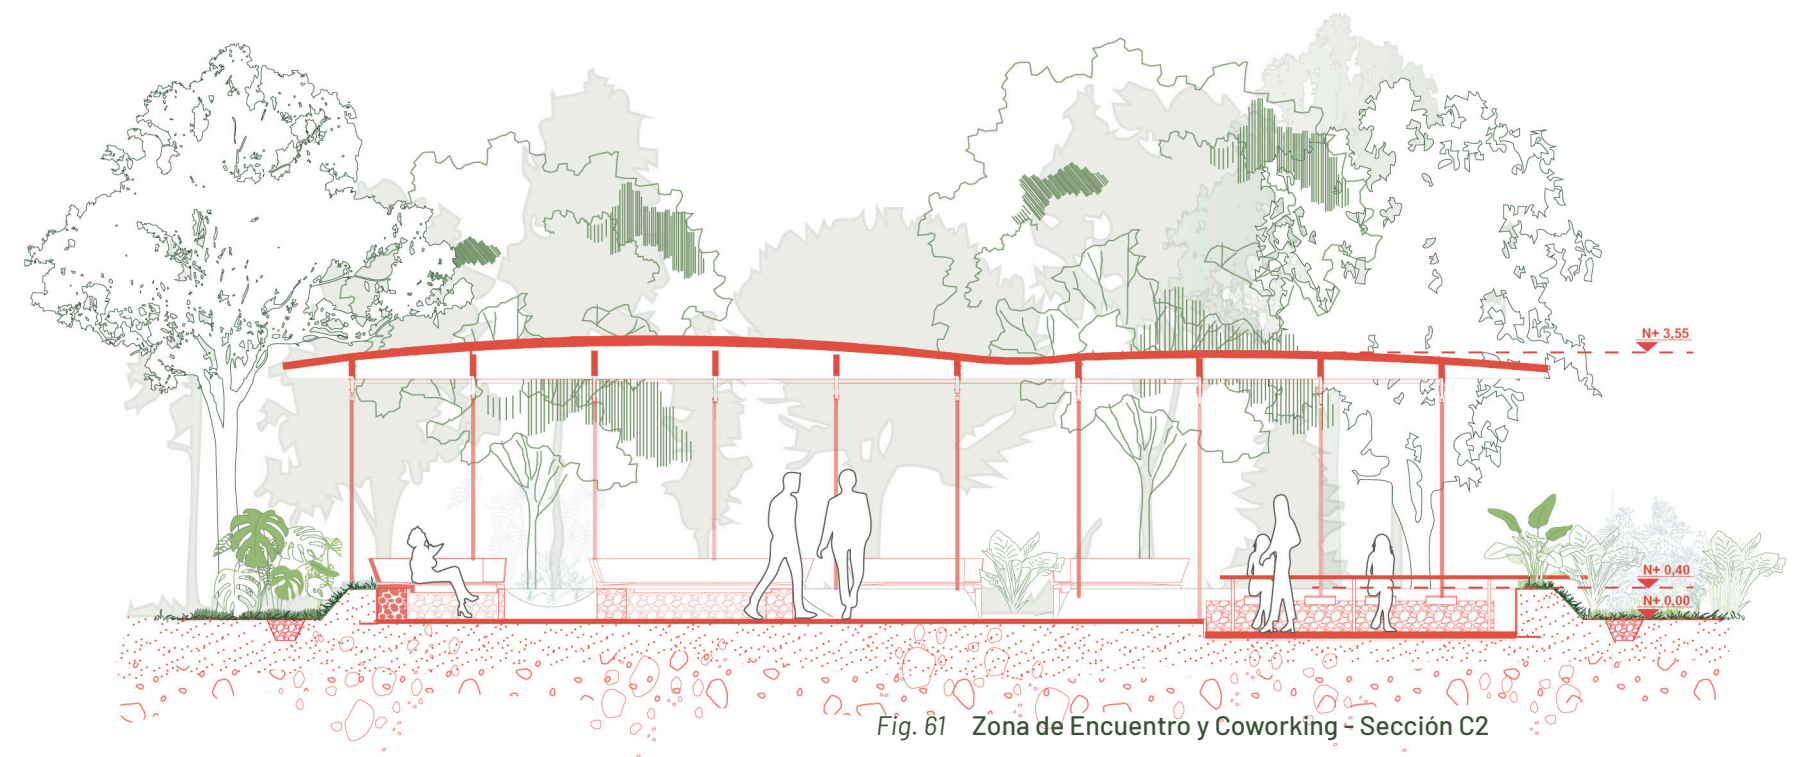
Zona de Encuentro y Coworking - Sección C2
